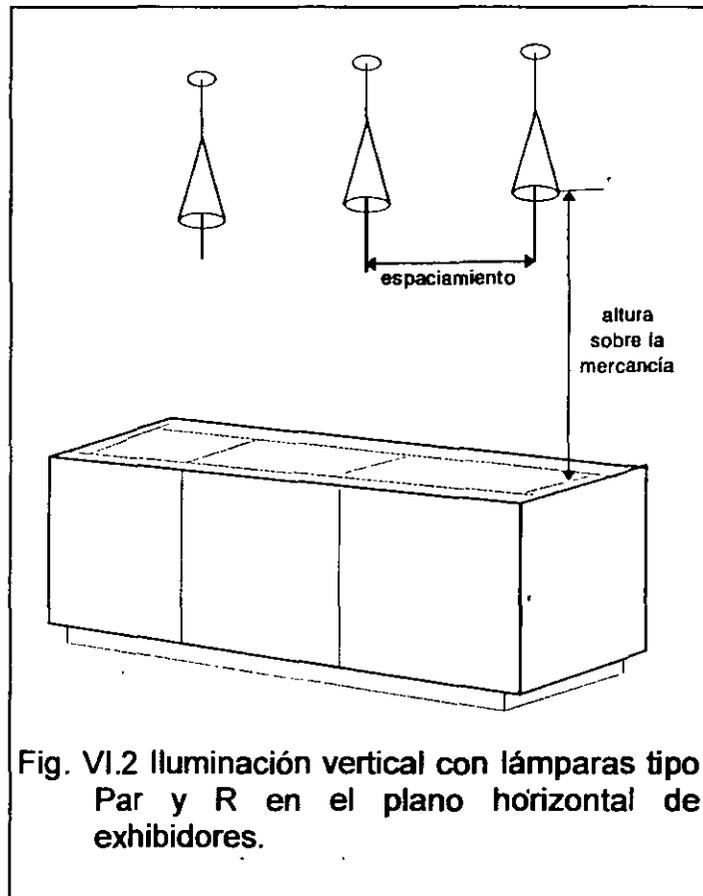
Iluminación vertical con lámparas tipo Par y R en el plano horizontal de exhibidores.
